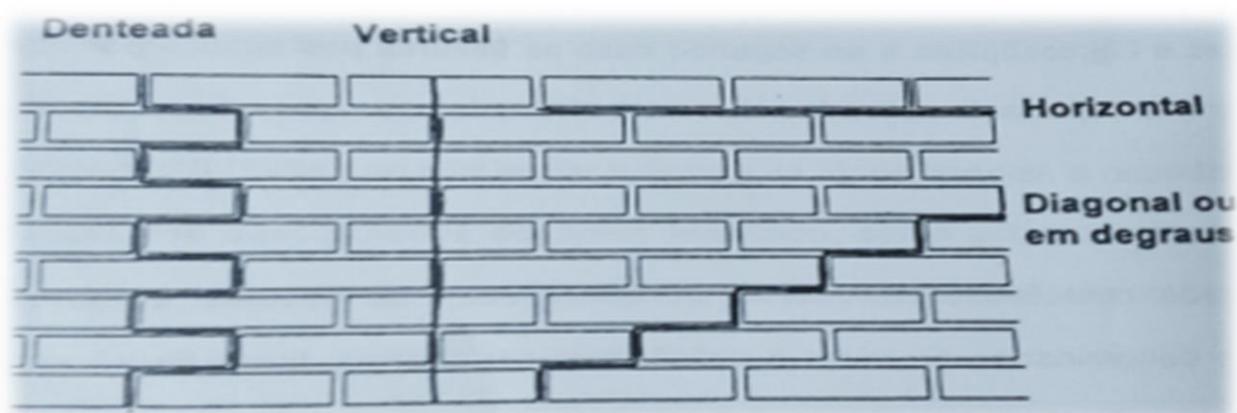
Classificação das fissuras nas alvenarias
